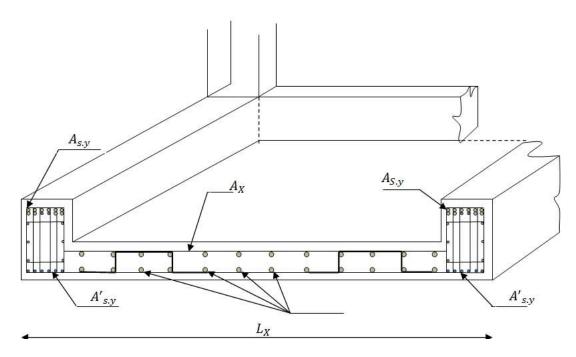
Schéma descriptif de disposition de ferraillage d'un radier nervuré
